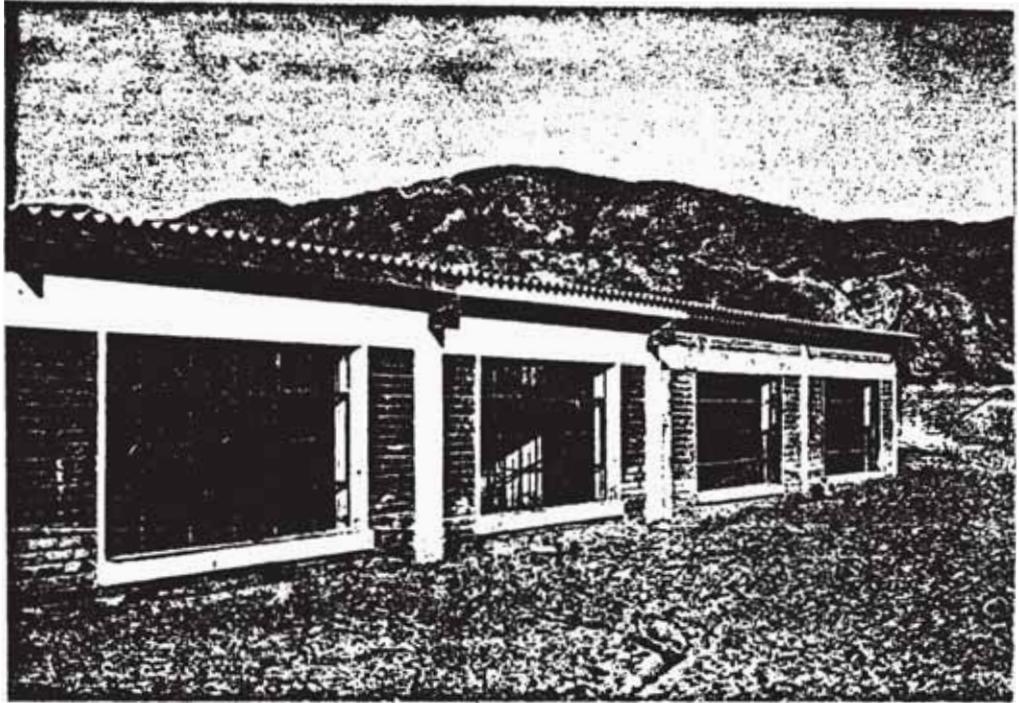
Colegio "Túpac Amaru", arenado por el torrente de la Qda. del Zanjón.
